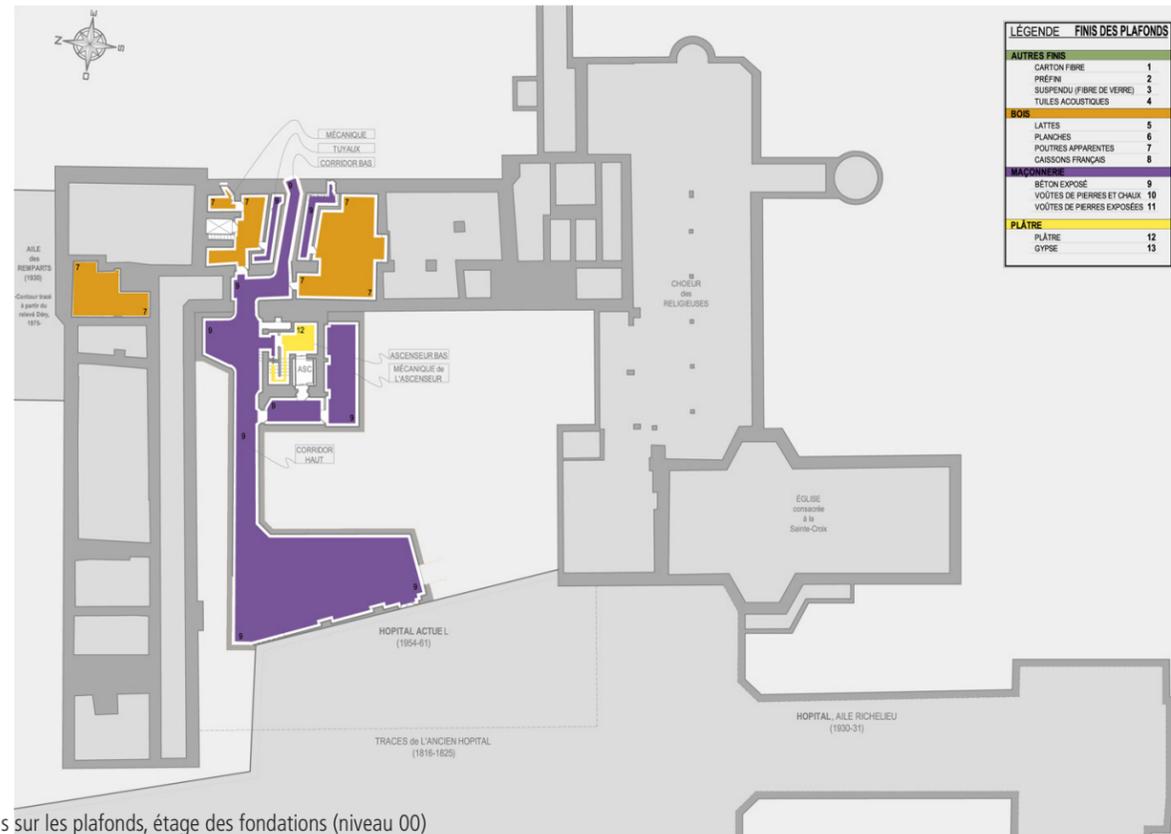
Plan des finis sur les plafonds, étage des fondations (niveau 00)
